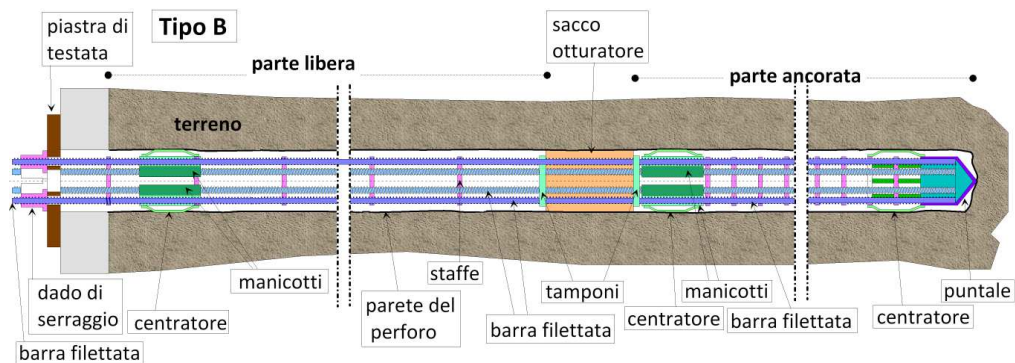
b: Sezione longitudinale del tirante tipo B
